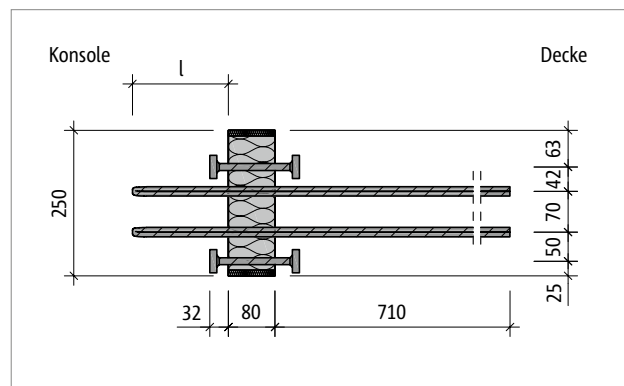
Schöck Isokorb® T Typ O-X80: Produktgrundriss
